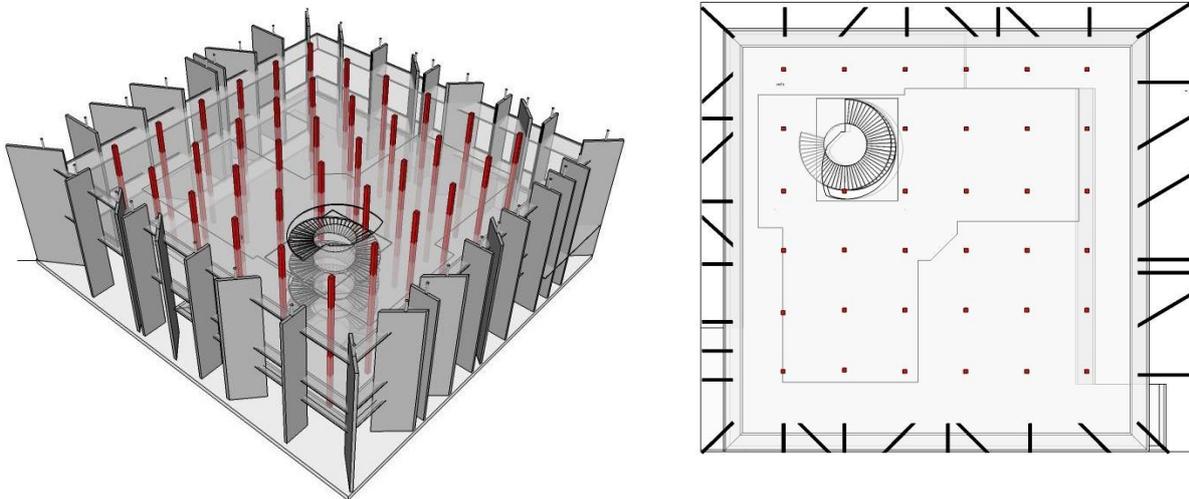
e 4 – Perspectiva e Planta baixa. Fonte: Elaborado pelos autores.
